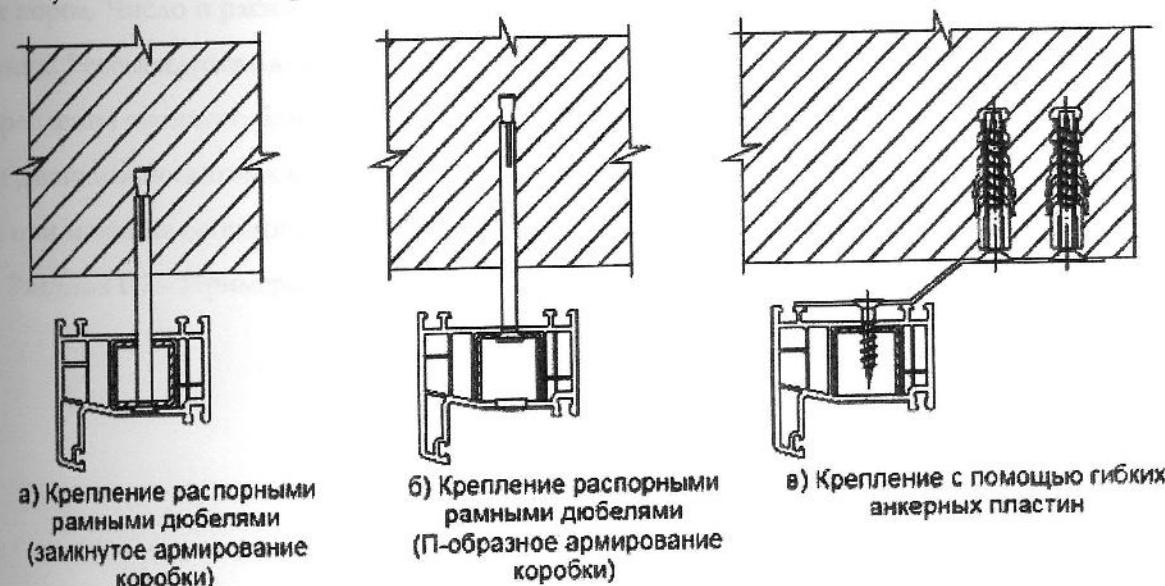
Схемы крепления оконных блоков к стене
